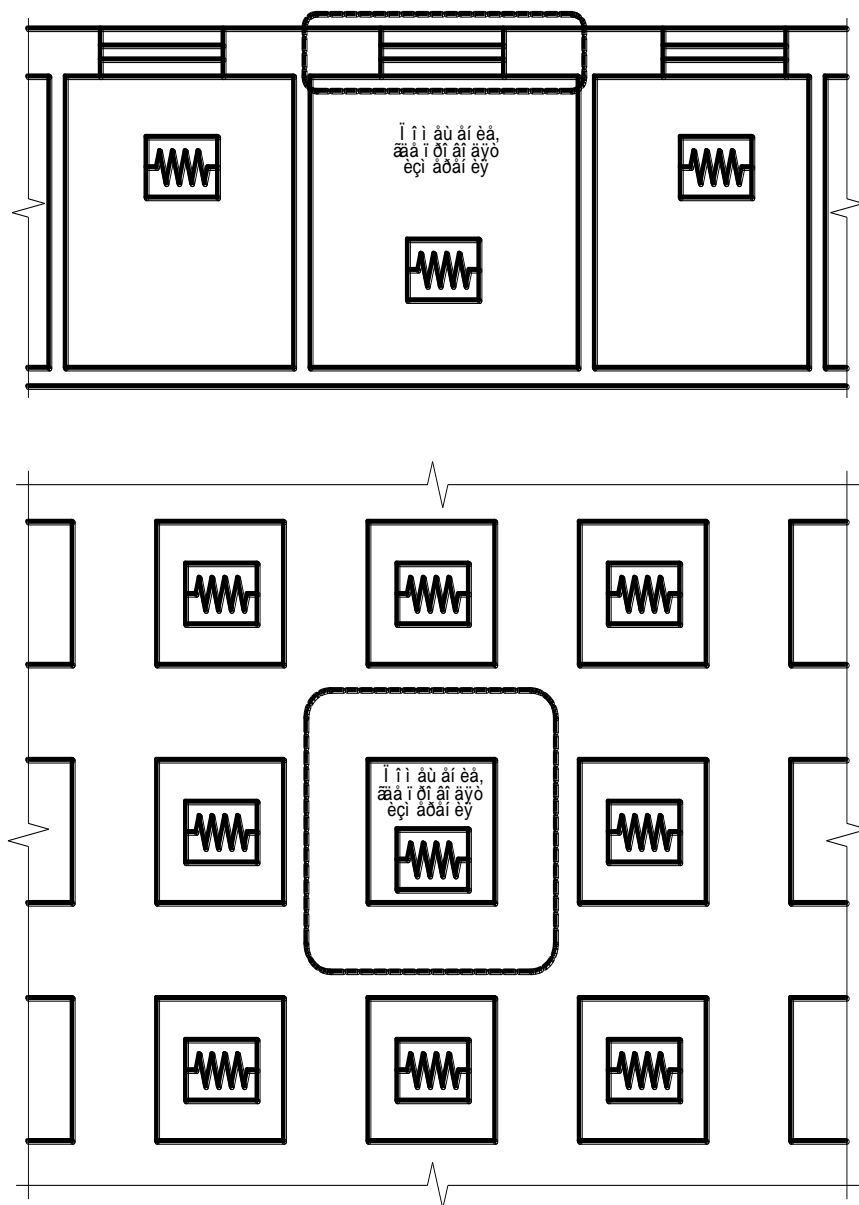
Размещение нагреваемых помещений по этажам
